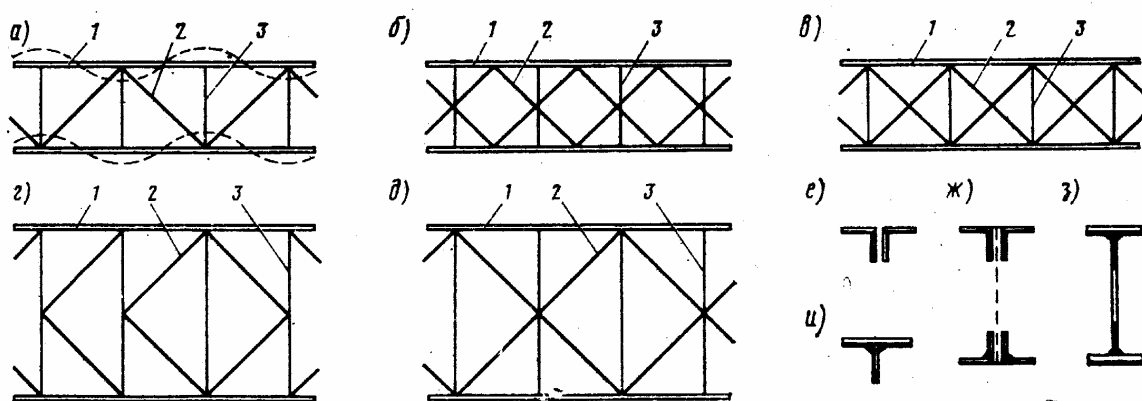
Схемы решеток и сечений элементов продольных связей
